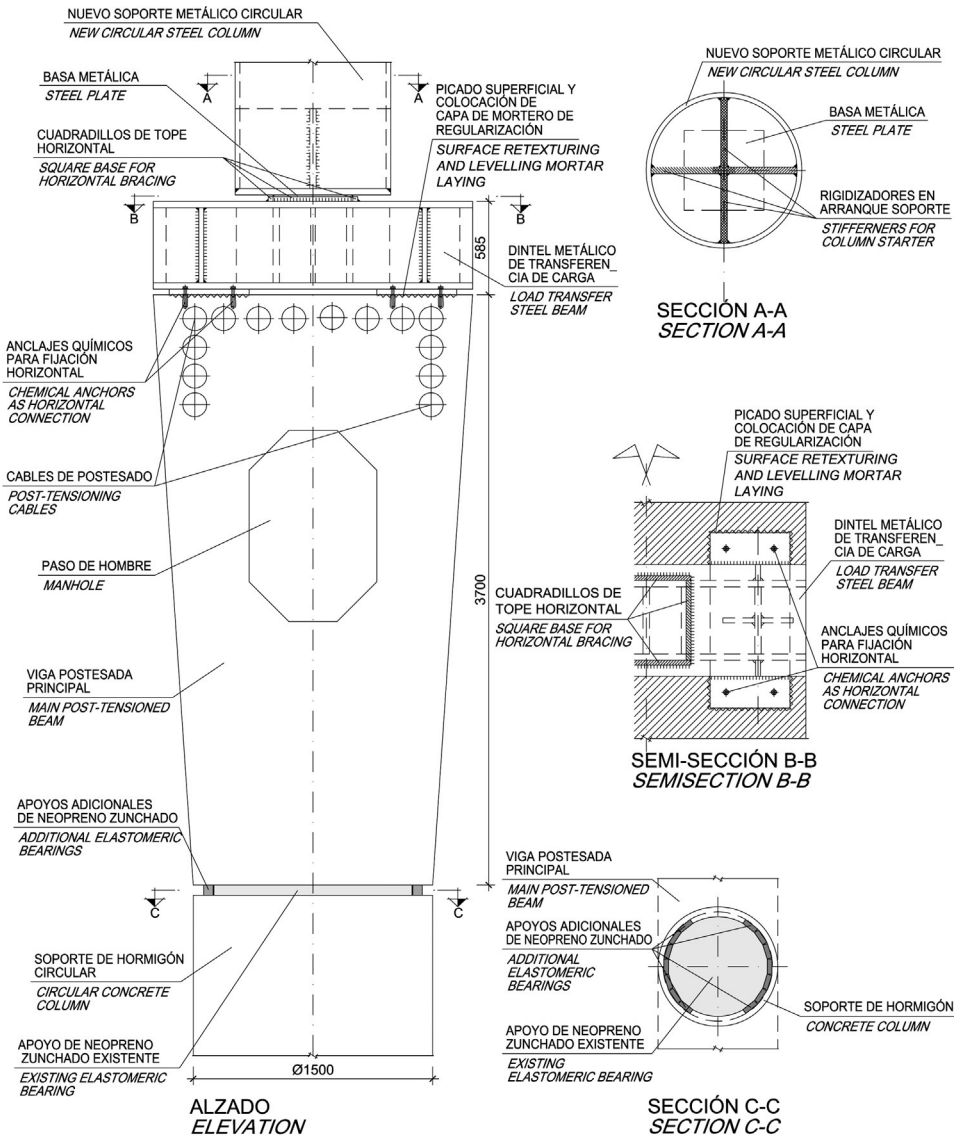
Detalle de apoyo del soporte metálico de cubierta en la viga principal postesada.
